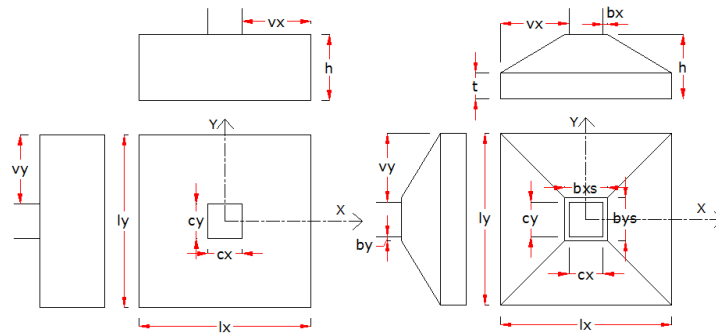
Dimensiones zapata de espesor constante y zapata tronco cónica piramidal, respectivamente. Fuente: elaboración propia.
